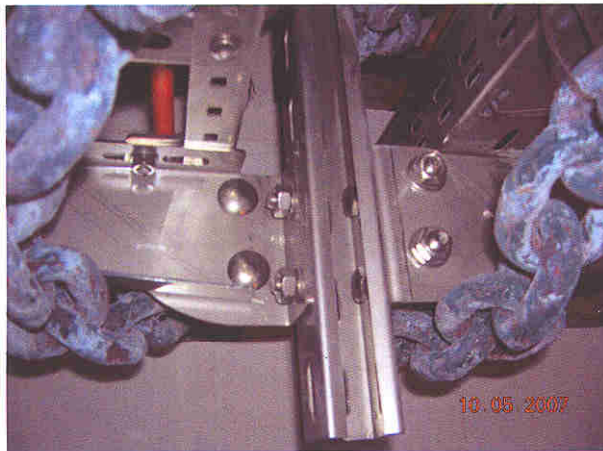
Detail: Anschluß der schwenkbaren Ausleger am Mittelprofil
